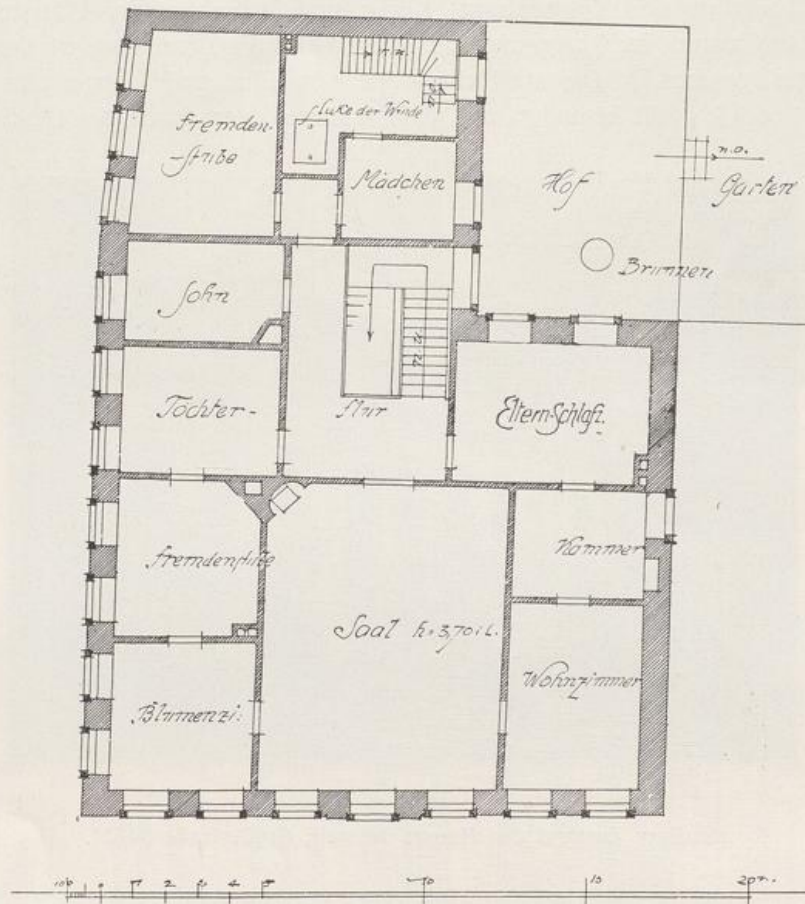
Haus Lange, Hegerstraße 27/28 (Obergeschoß). J
